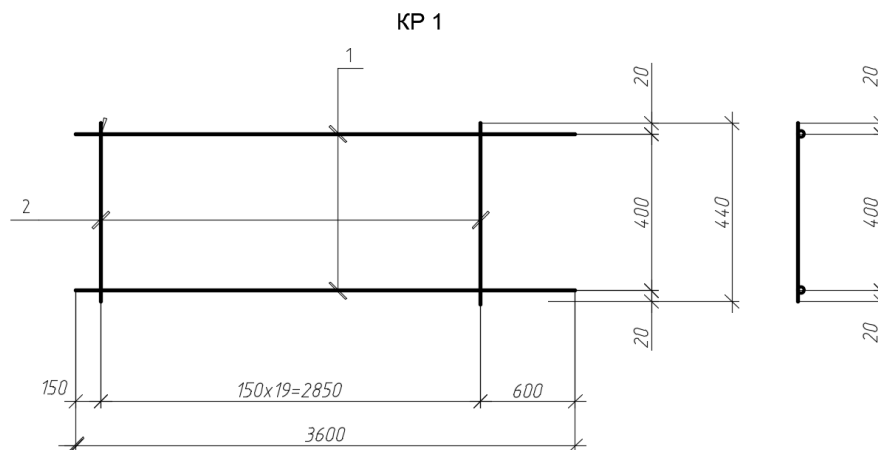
Армирование ростверка из буронабивных свай, КР 1
